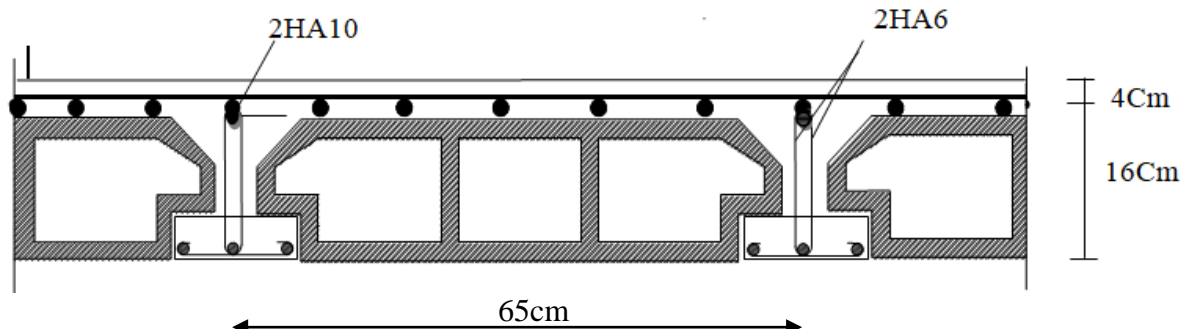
Ferrailage des poutrelles aux appuis.
